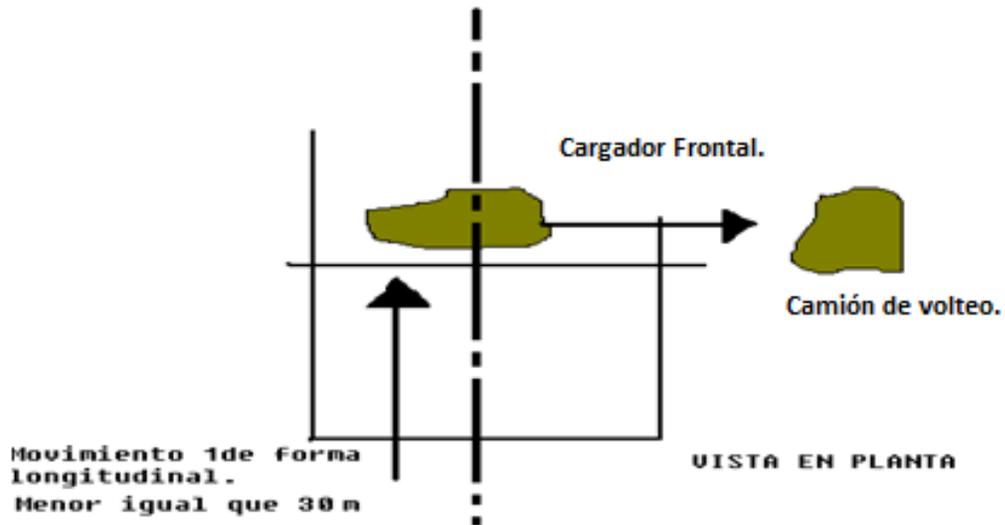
Vista en planta. Fuente: Simoneaux, (2009)
